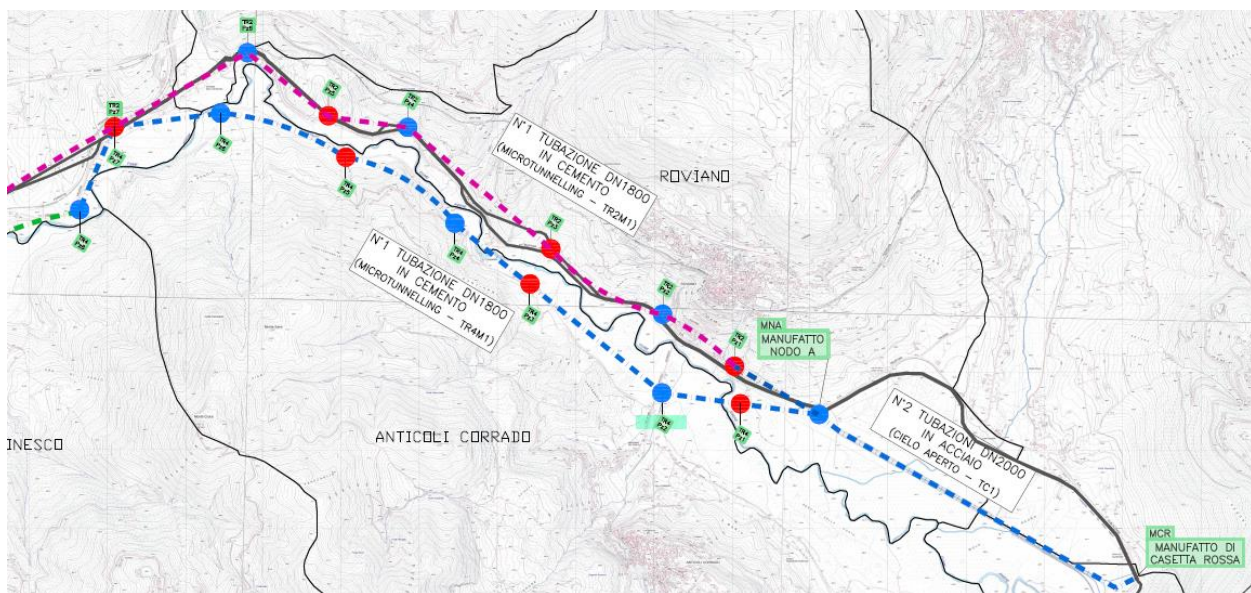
Planimetria della prima fase funzionale (in blu) del Nuovo Acquedotto Marcio
